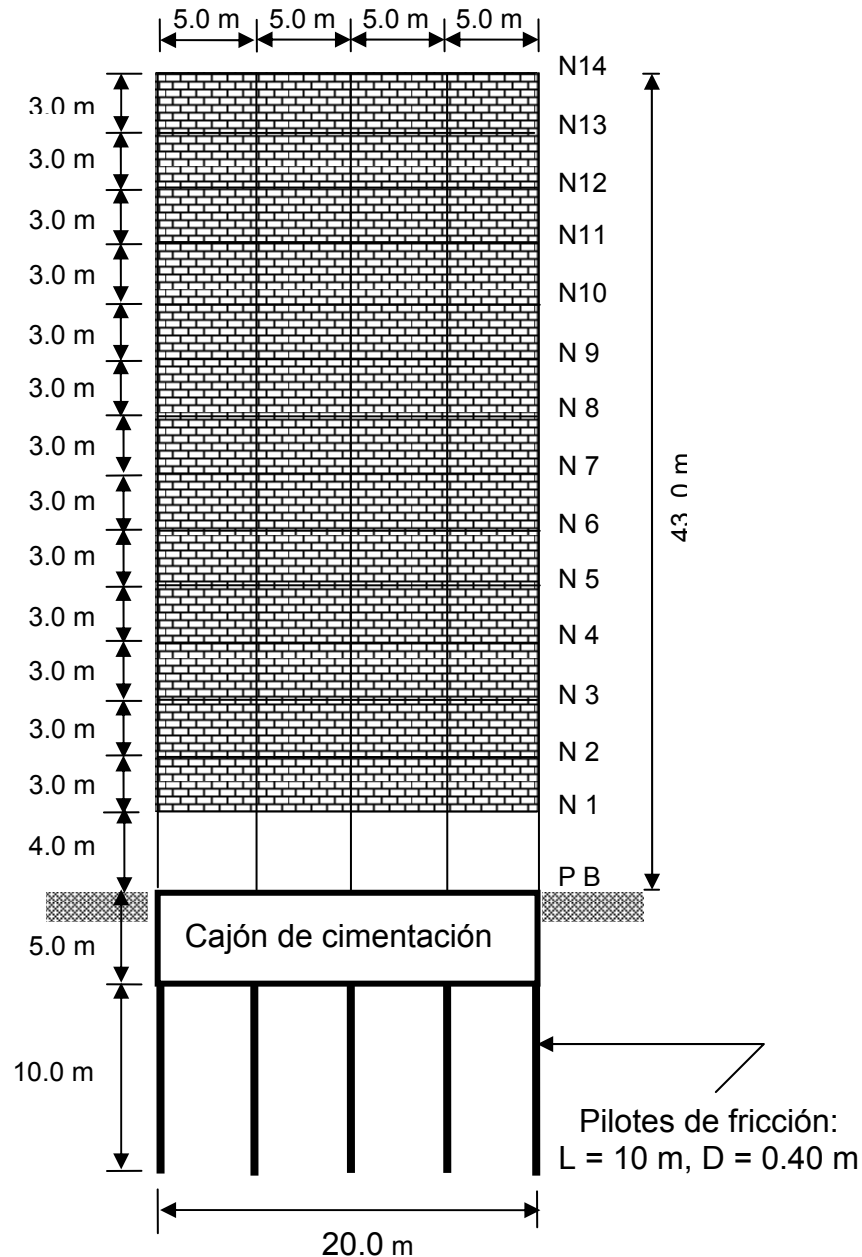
Vistas en elevación (corte b-b) de la estructura de 14 niveles
